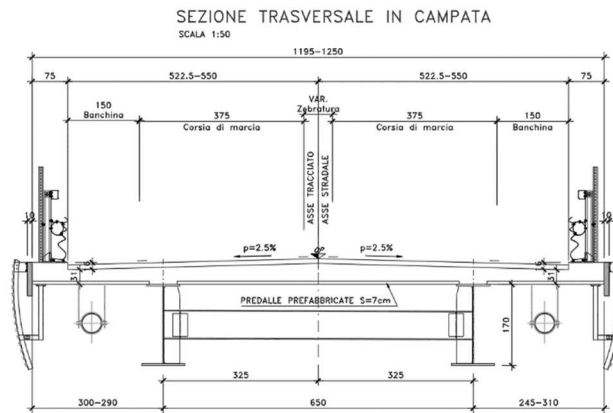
Sezione trasversale Ponte tipo impalcato tipo in campata
